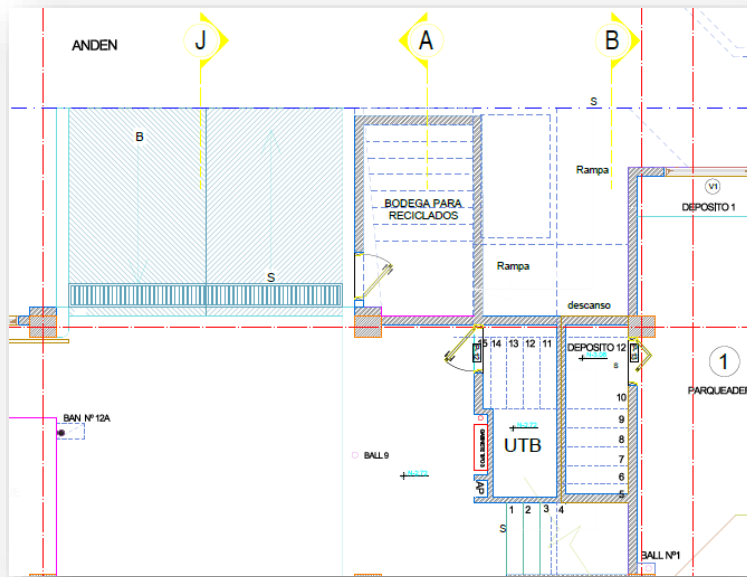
Diseño ajustado para bodega de reciclados, vista en planta
